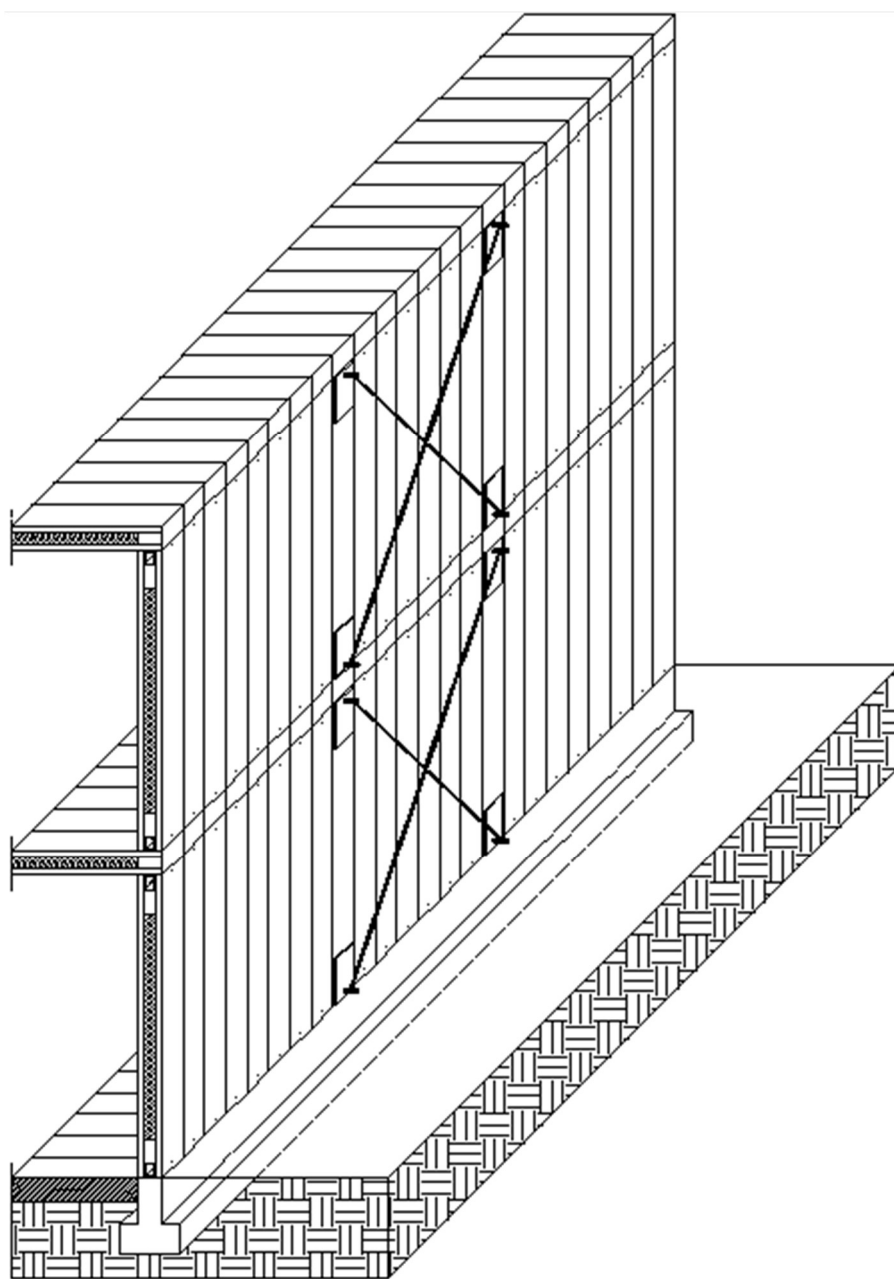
Assonometria porzione di parete perimetrale edificio POREPAN
